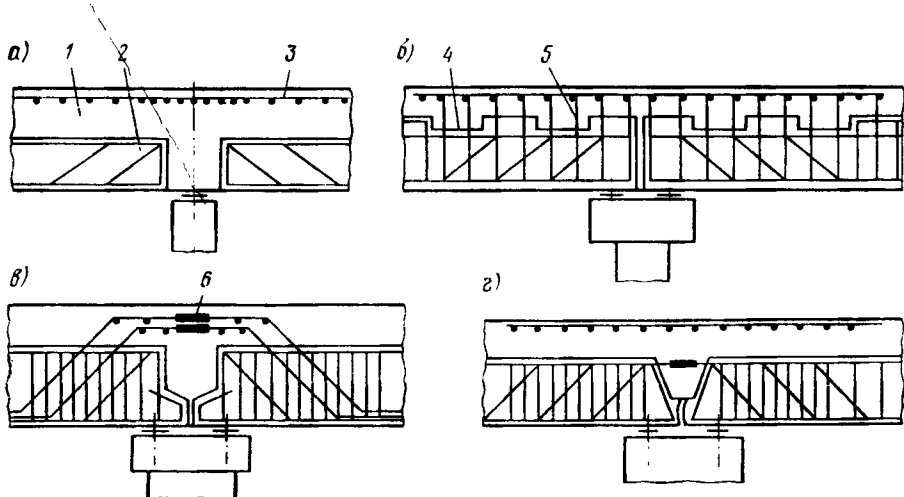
Конструкция надпорных стыков с ненапрягаемой арматурой сборно-монолитных пролетных строений:
